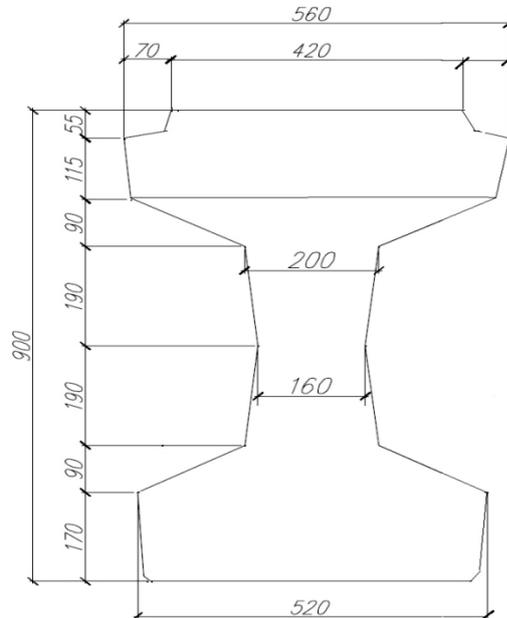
Поперечный разрез балки типа «3 Бет-90»
